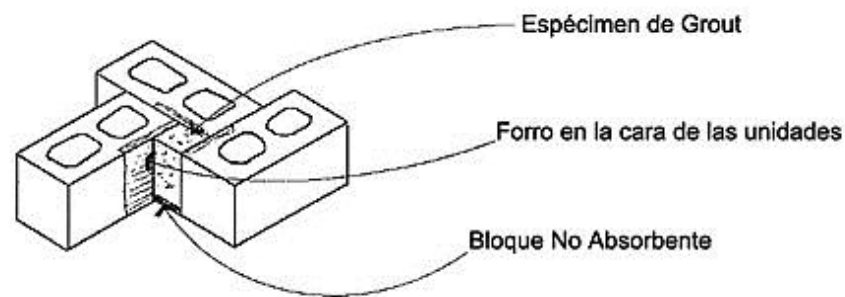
Molde del Grout - Unidades mayores de 152.4 mm de alto, 203.2 mm es la altura mostrada de la unidad de mampostería de concreto (Frente a la pila de unidades de mampostería no se muestra un bloque para permitir la vista del espécimen)
